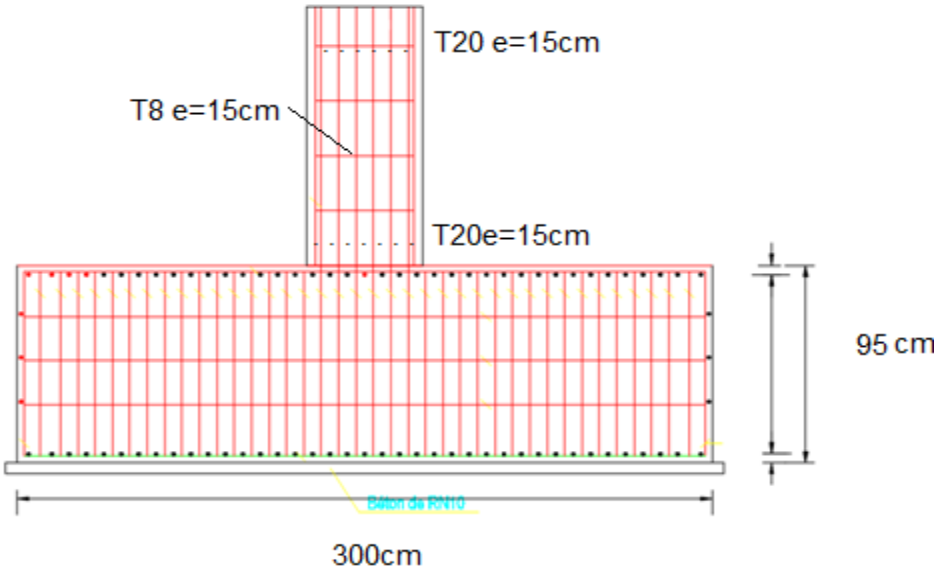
ferrailage fondation d'appuis d'escaliers coté
